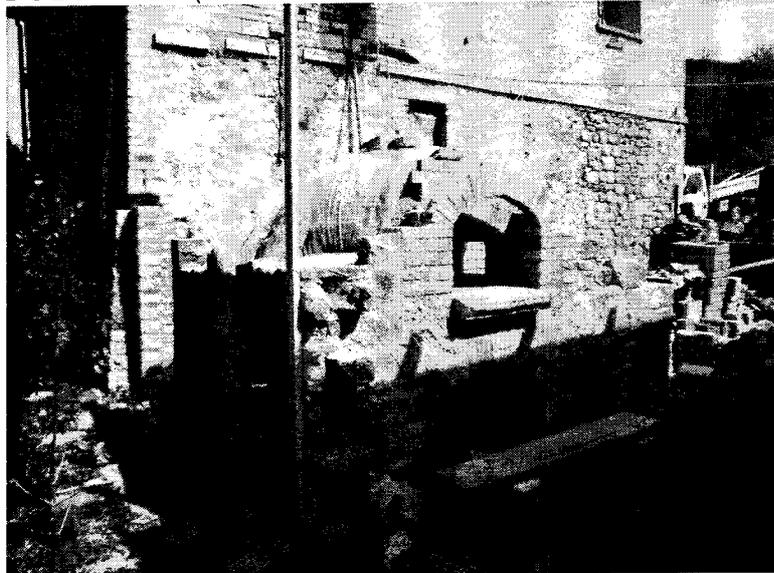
(Tettoia esterna – Lato Sud/Est – Nord/Est)
